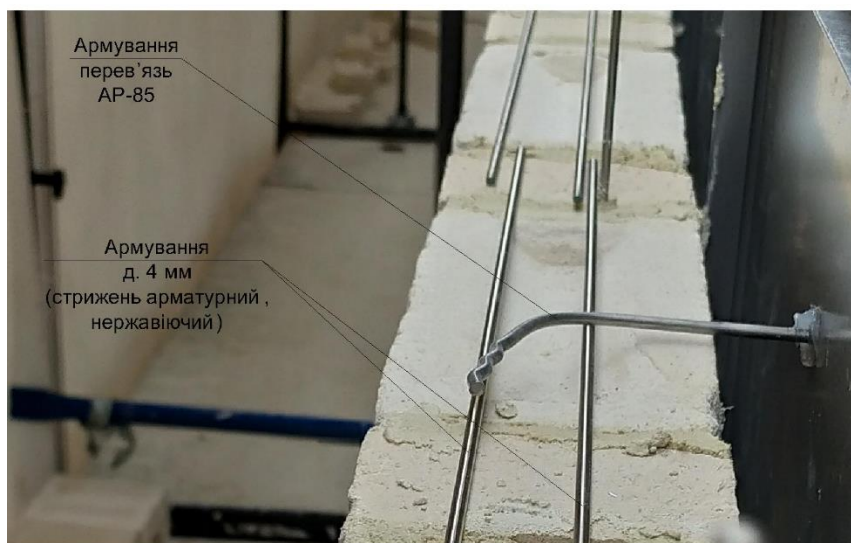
Конструктивне рішення зовнішніх стін фрагменту фасаду. Армування верхніх рядів
